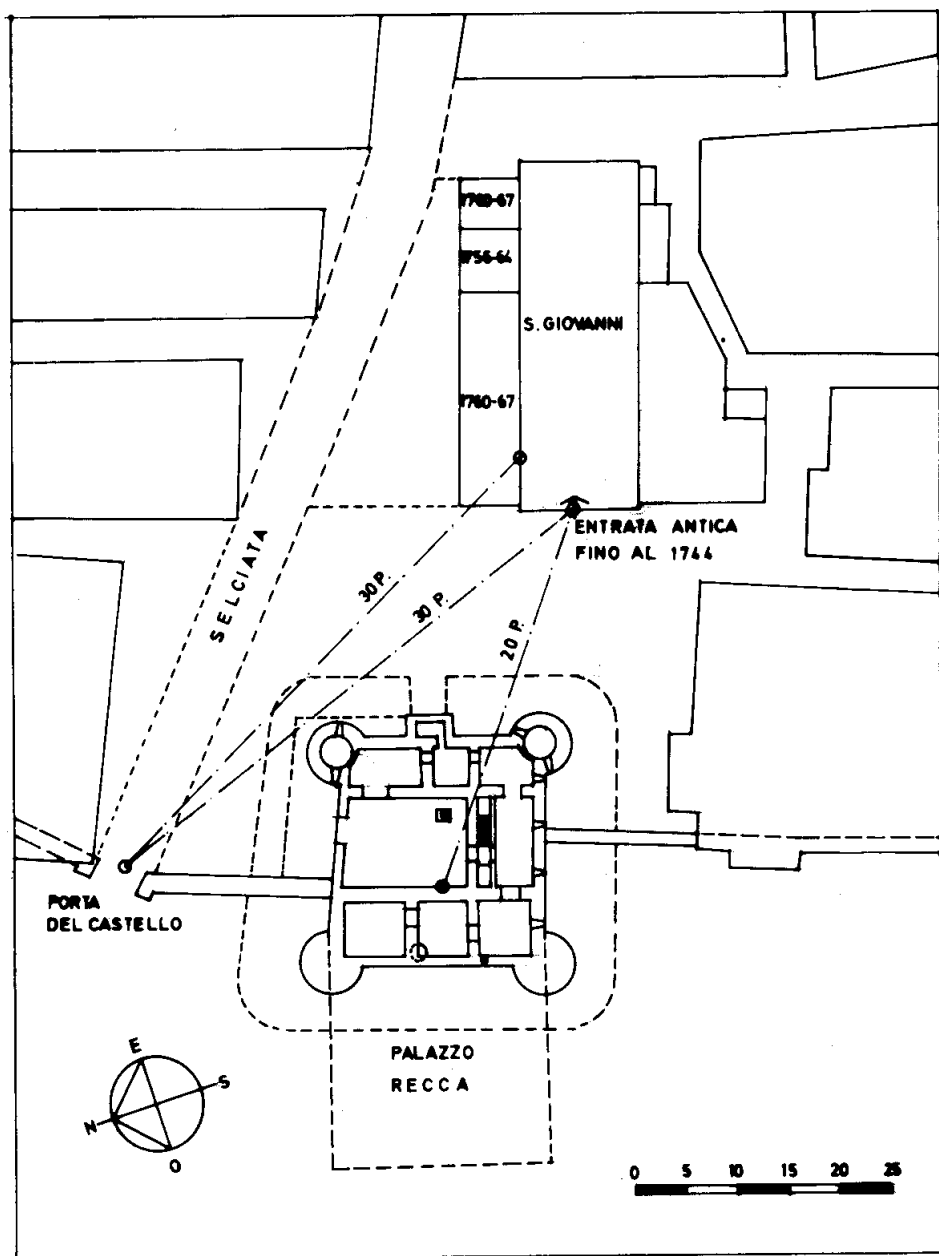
Planimetria con l'indicazione delle distanze rilevate dall'agrimensore Fantasia
